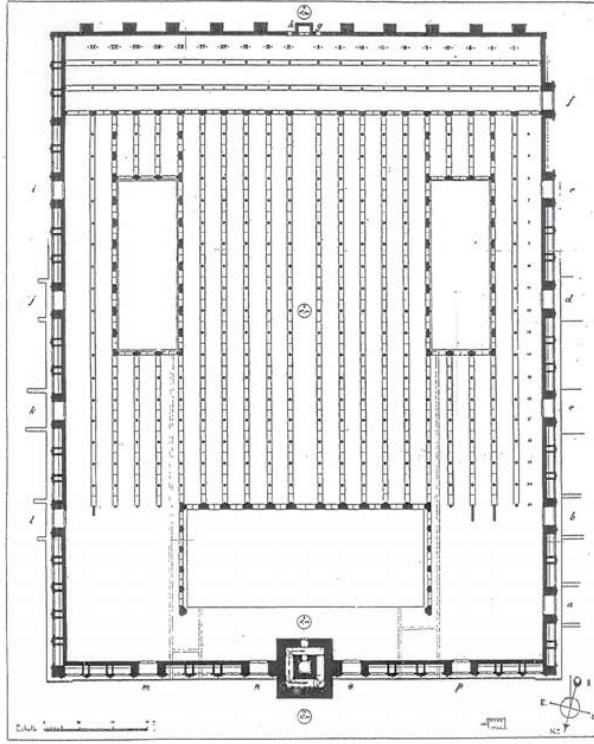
جامع تازا، مسقط أفقي مفترض، خلال العصر الموحد، عن:
